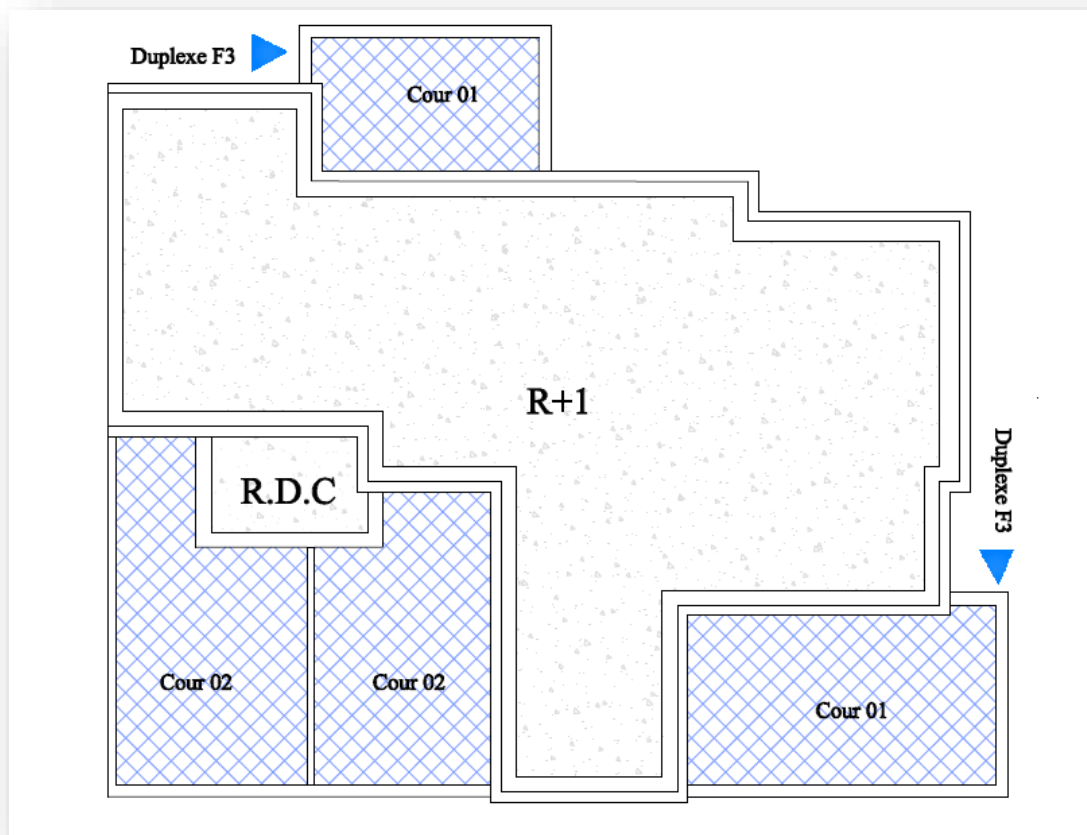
VUE EN PLAN DE TOITURE REALISE PAR AUTOCAD
